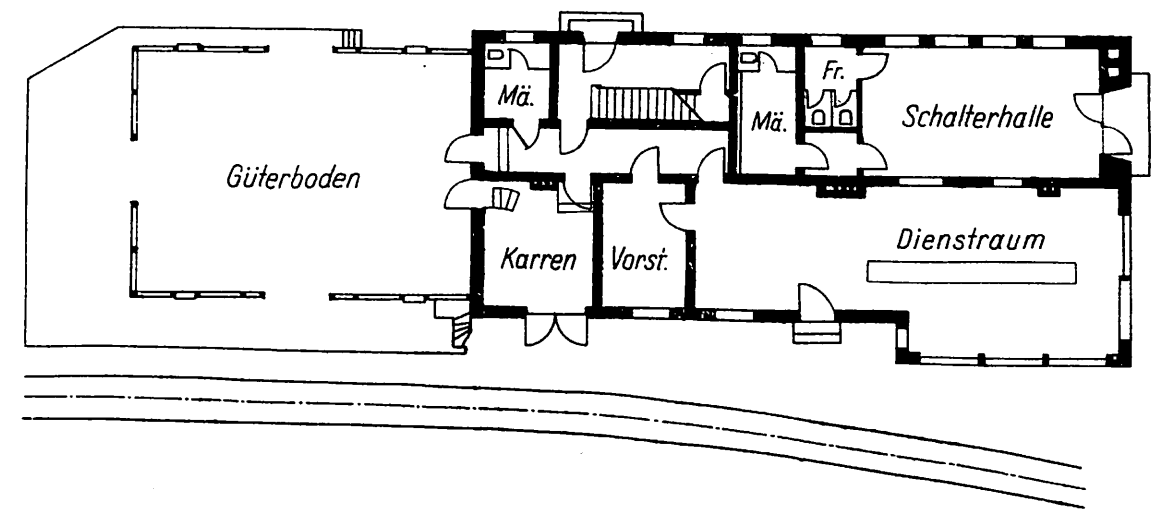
Lageplan zum Bahnhof Bärenstein.
